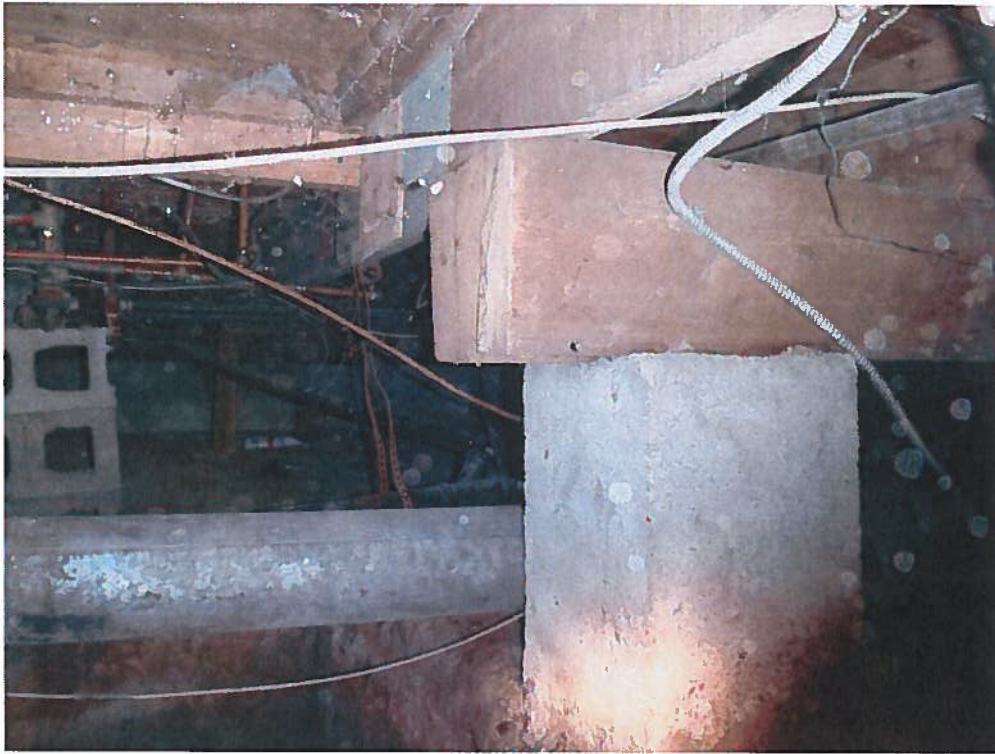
Poutre maîtresse coupée à côté d'une colonne d'origine en béton vers le milieu du bâtiment
